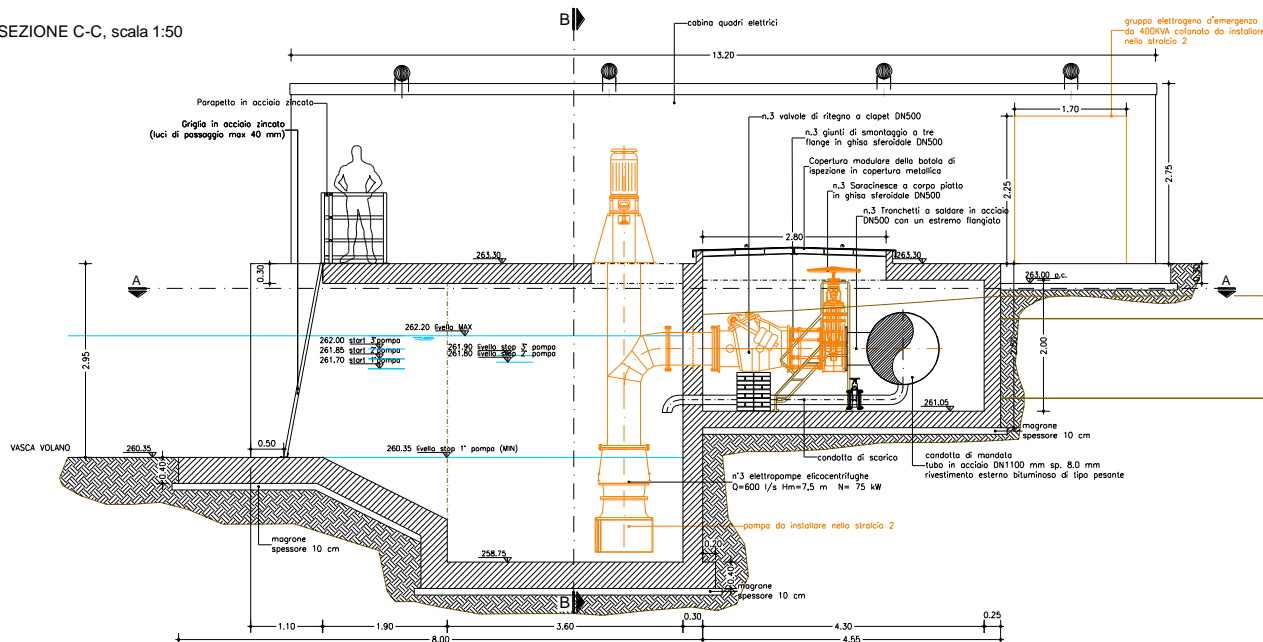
sezione dell'impianto idrovoro (estratto elaborato T-07). In arancione le opere previste nel 2° stralcio funzionale
